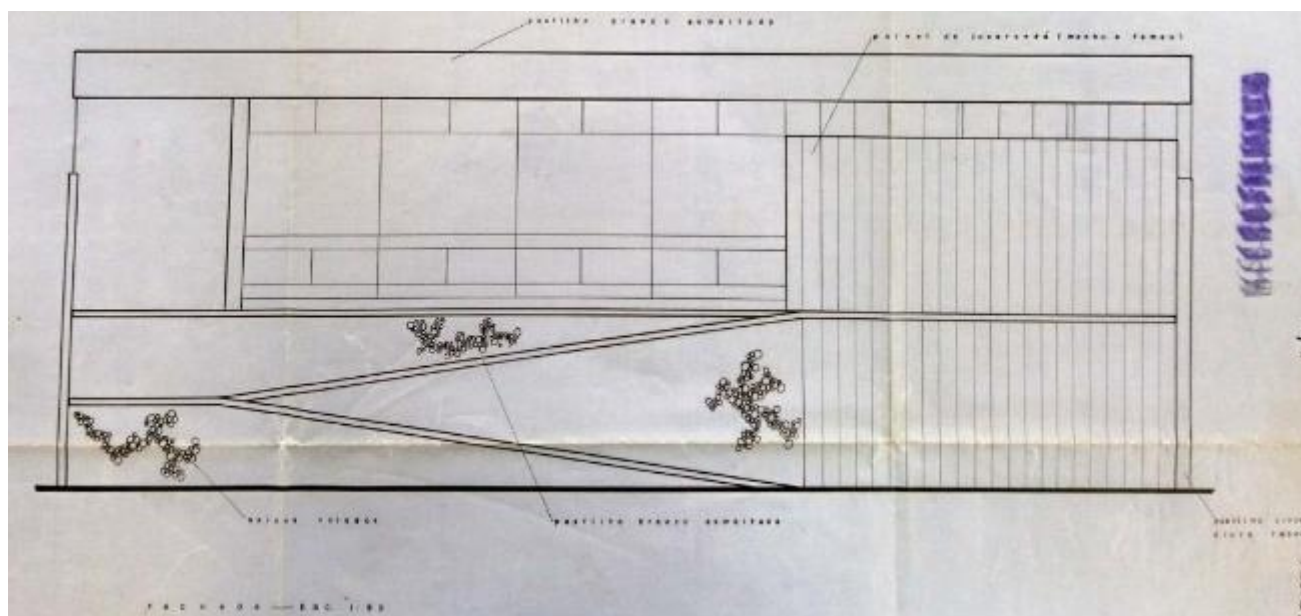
Fachada da edificação segundo projeto aprovado em 1936. Detalhe prancha 2 de 3. Fonte: APCBH.
